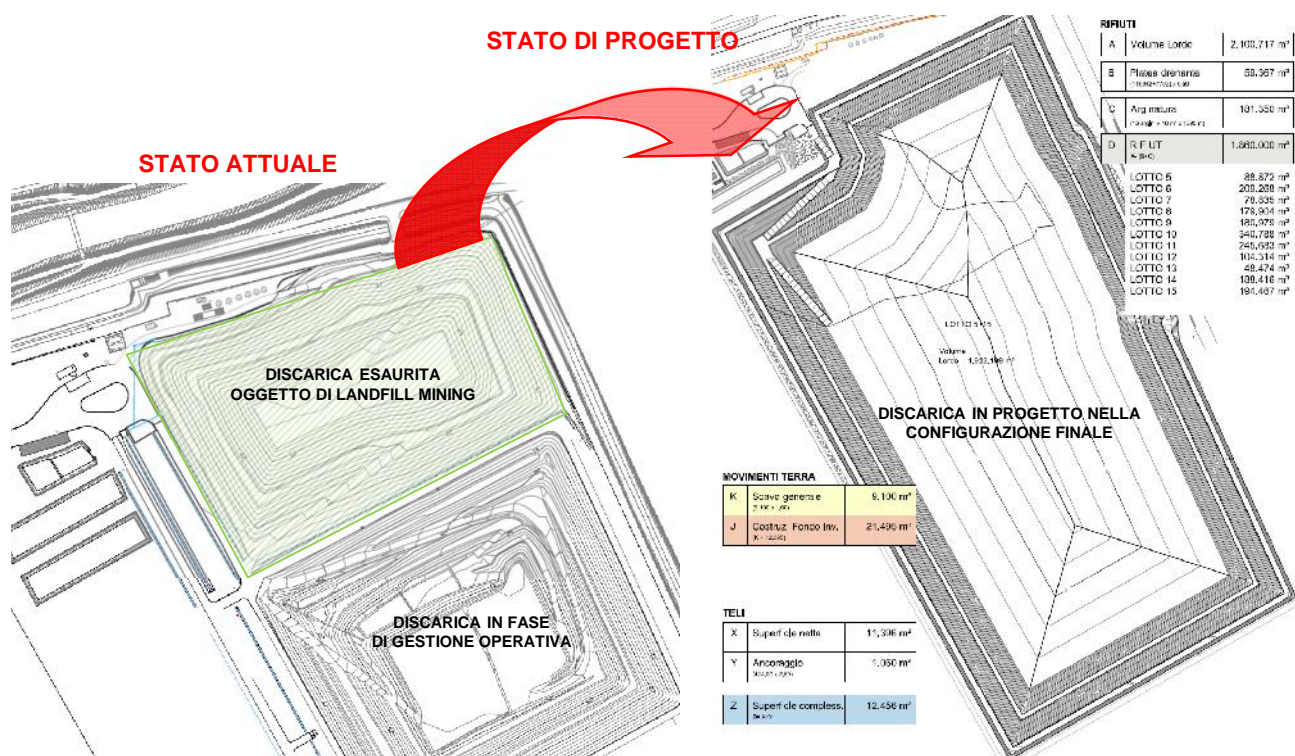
Planimetria delle aree di intervento. Assetto attuale e assetto di progetto
